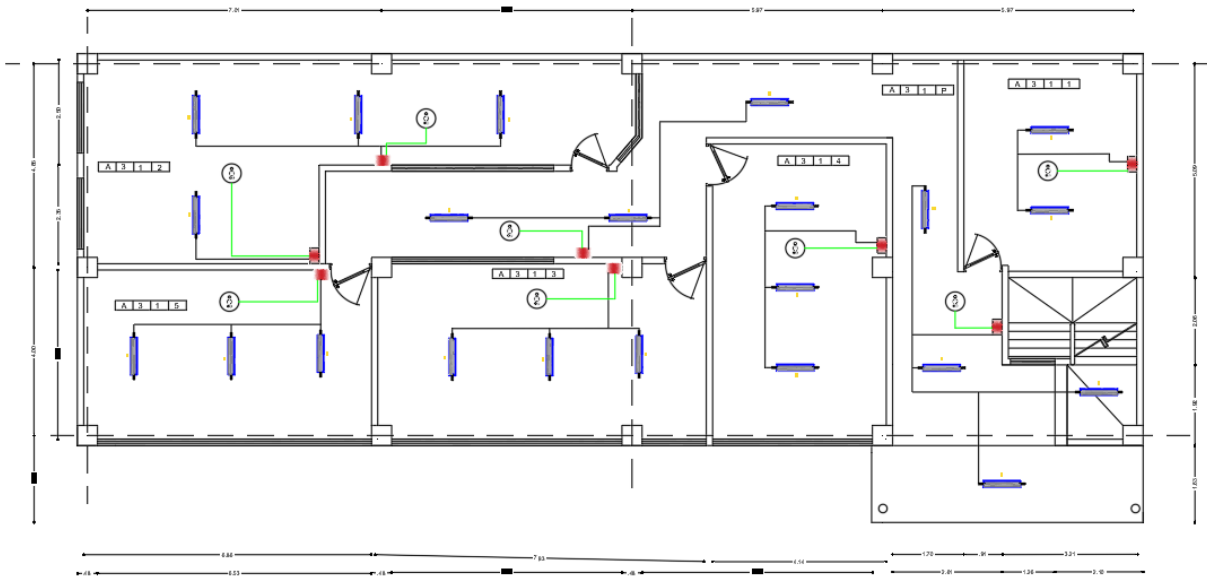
Circuito unifilar del sistema de control automático planta baja.
